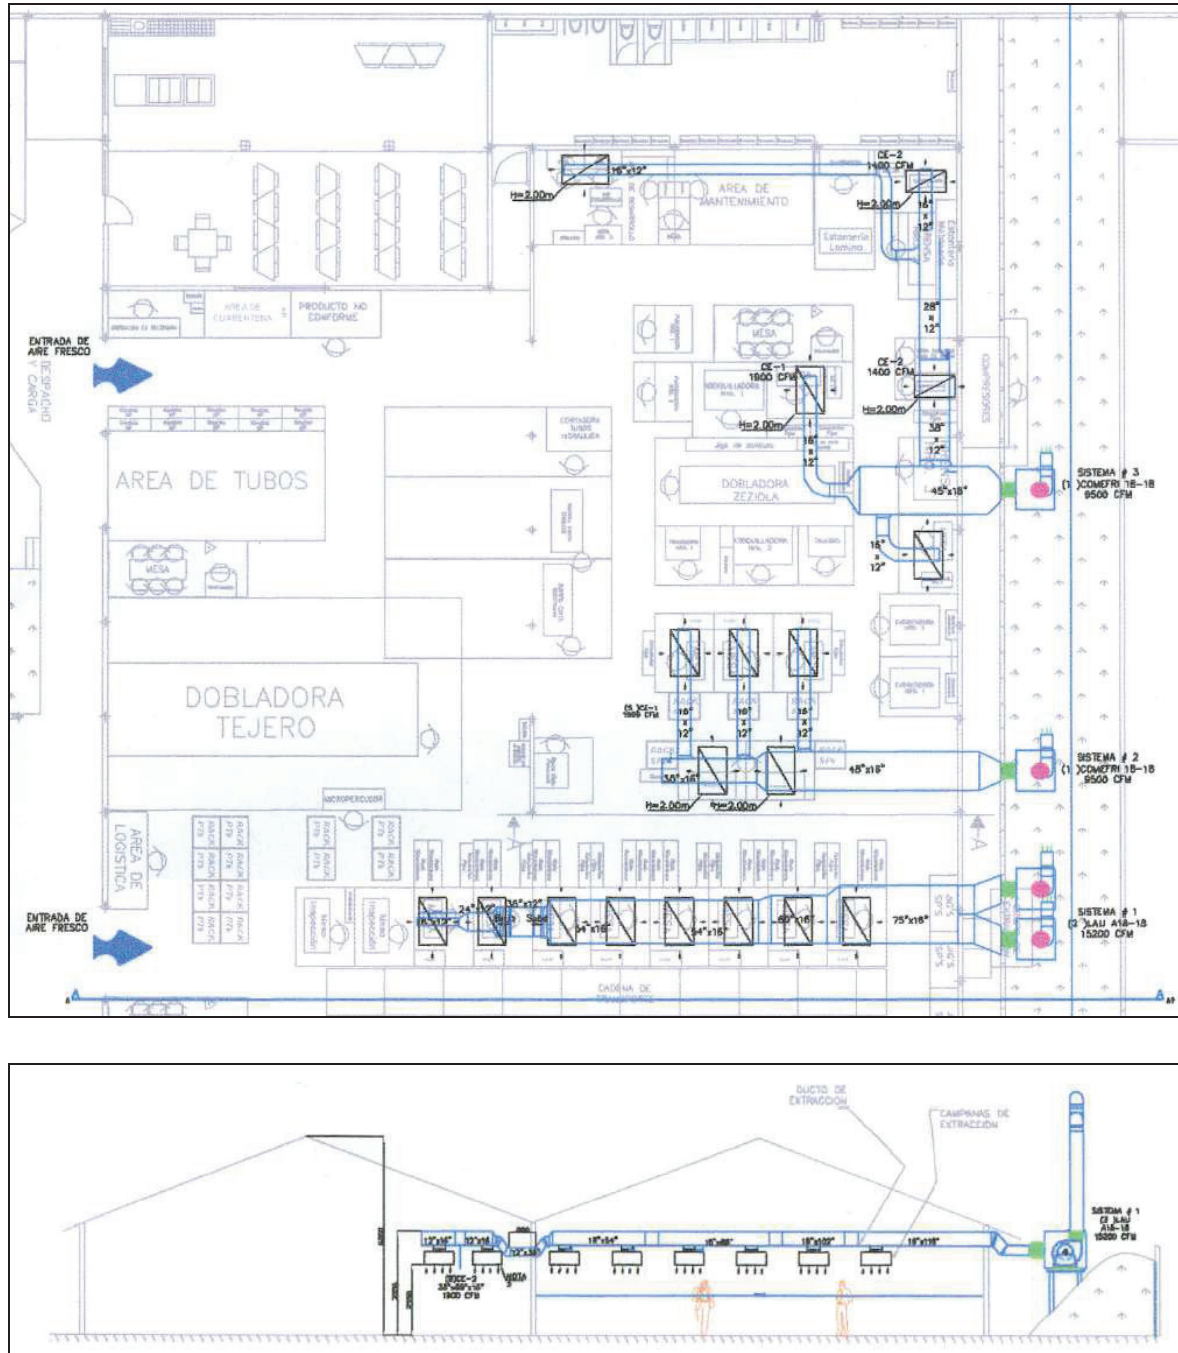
Sistema de extracción de gases de soldadura INDIMA S.A.
